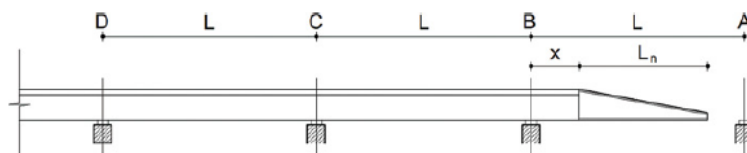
Fase 1, pico de lanzamiento en el aire
